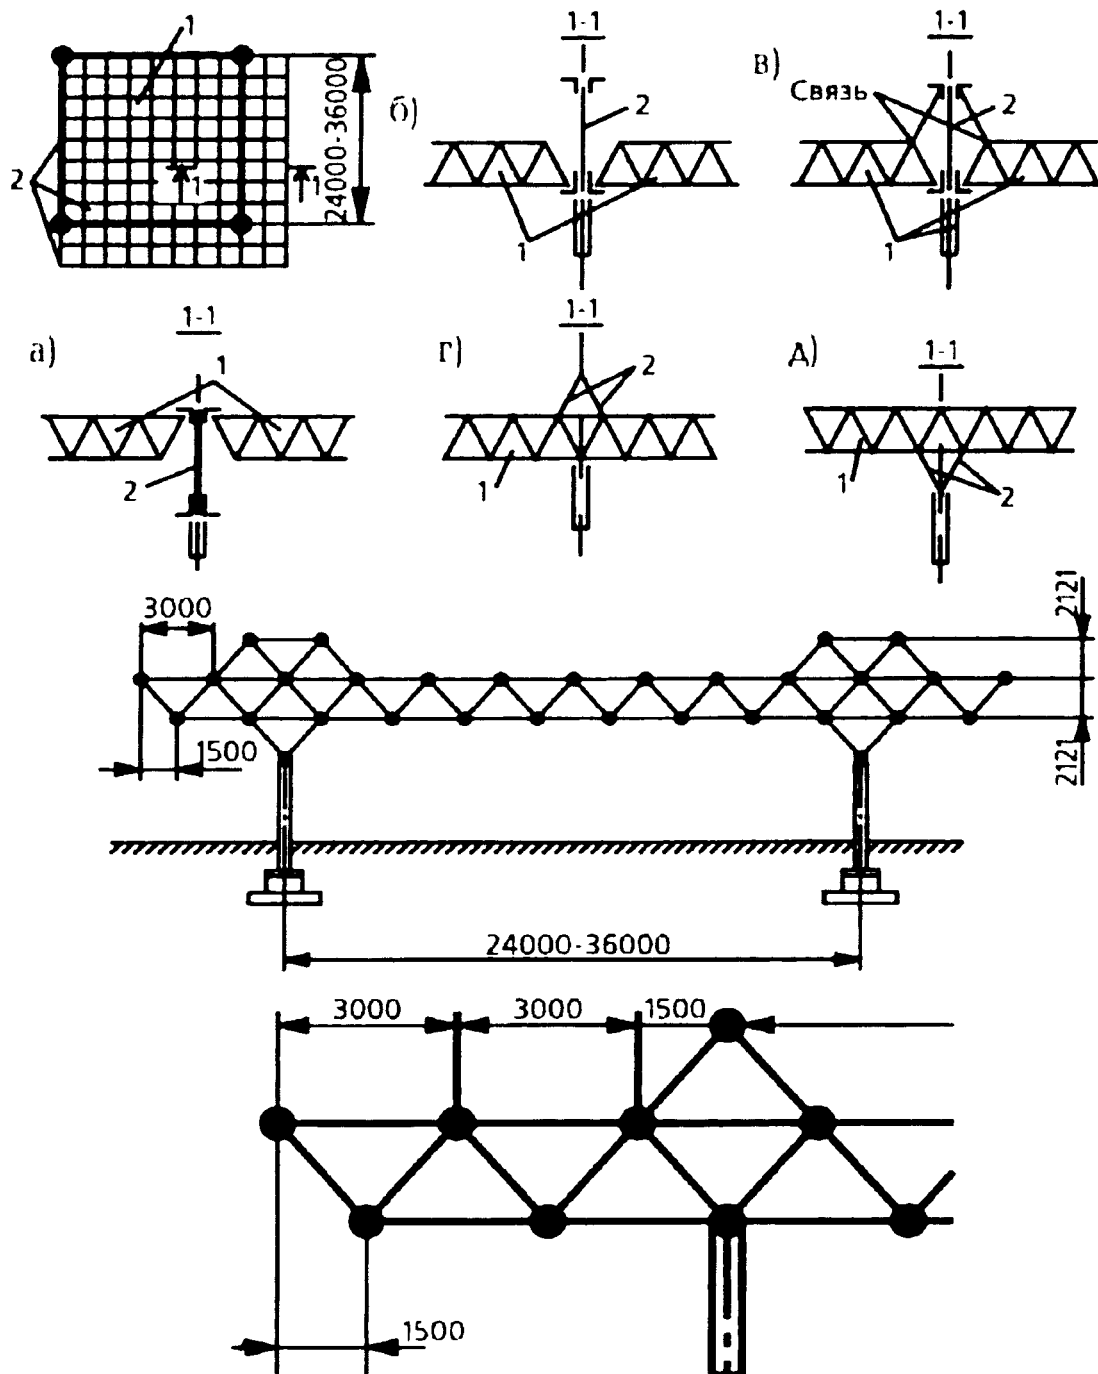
Структурные конструкции: а-д - варианты опирания перекрестно-стержневой пространственной конструкции (1) на подстропильные фермы (2)
